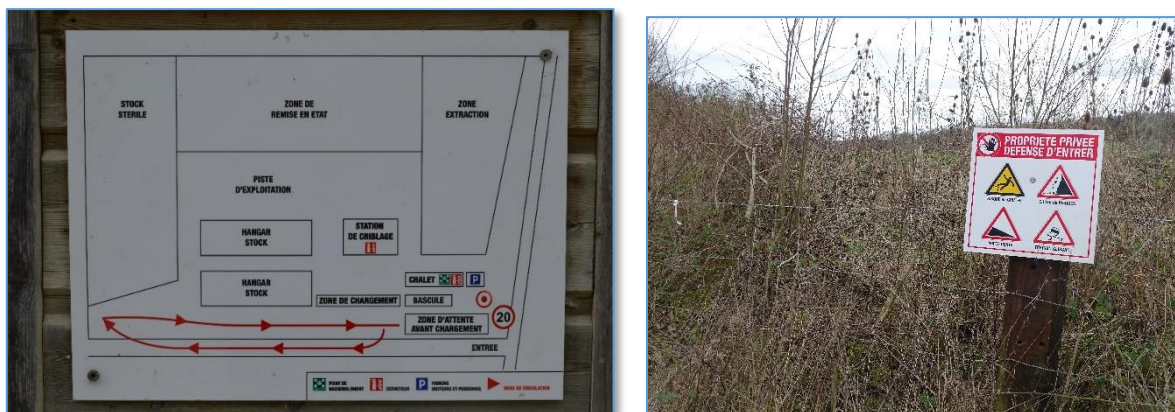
Plan de circulation sur la carrière et Vue sur les panneaux disposés sur le pourtour du site
